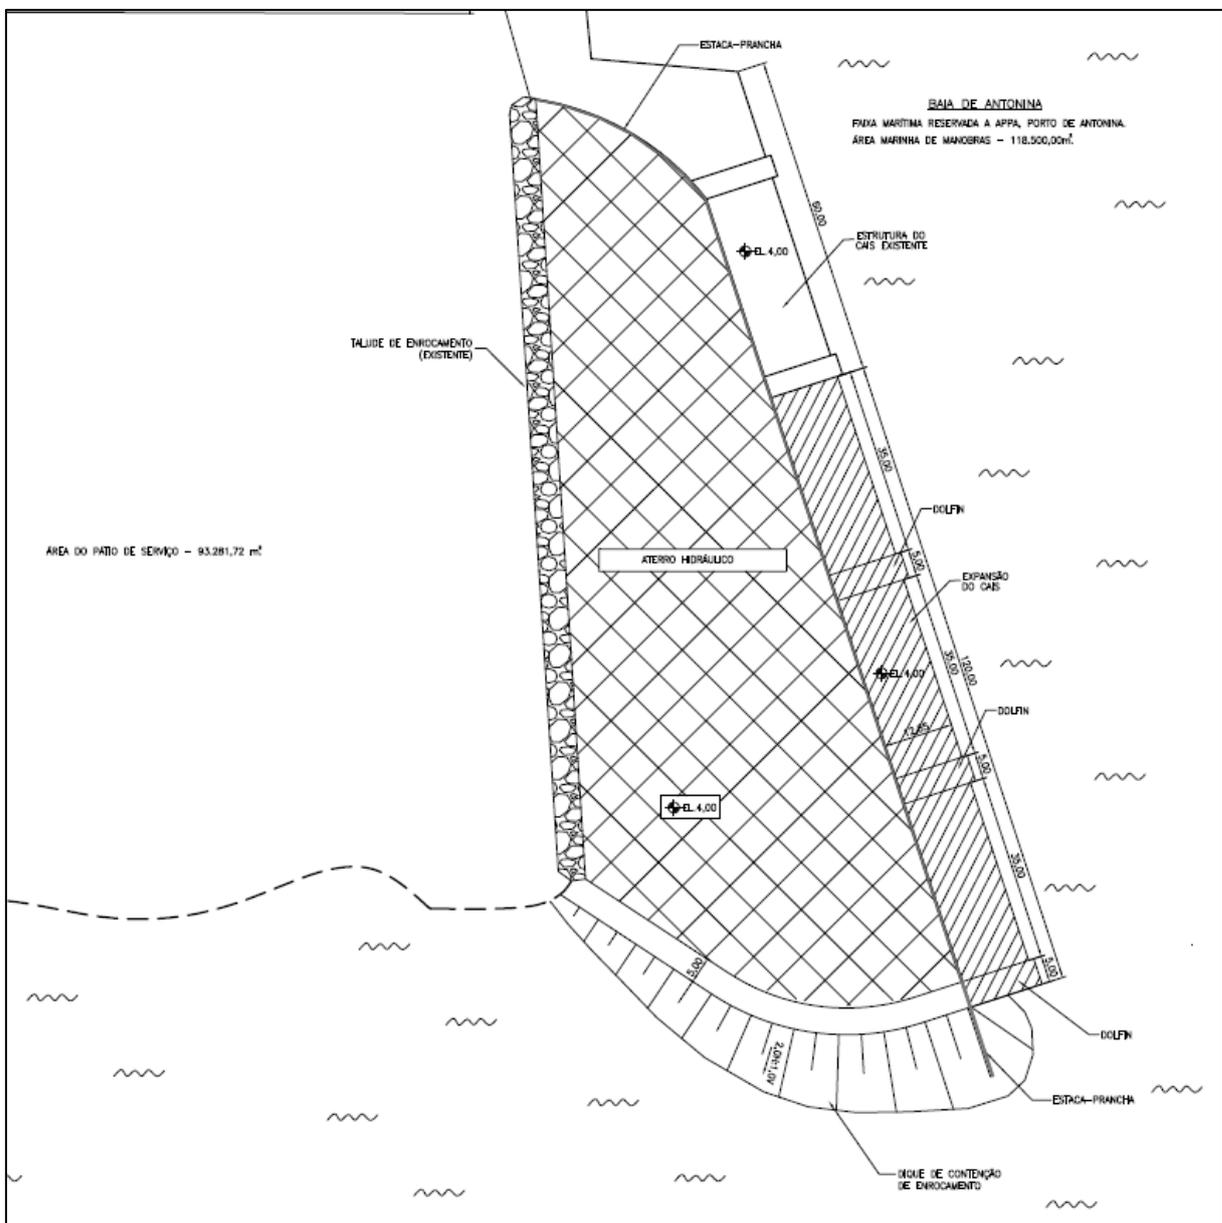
Planta Geral da Ampliação do Terminal Barão de Teffé
